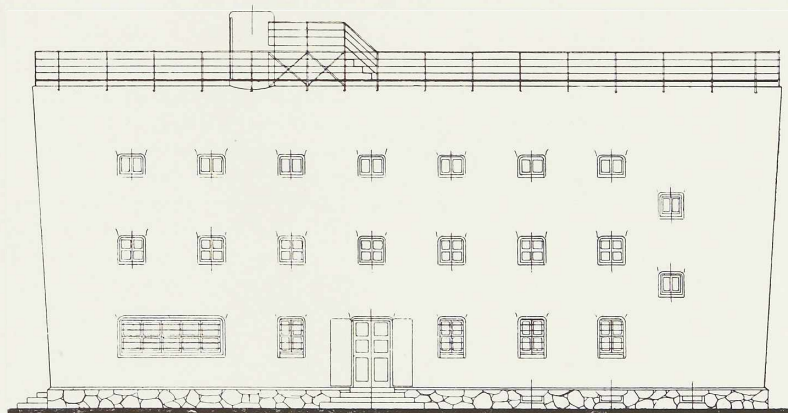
Vue en élévation d'une façade latérale incurvée du refuge.
